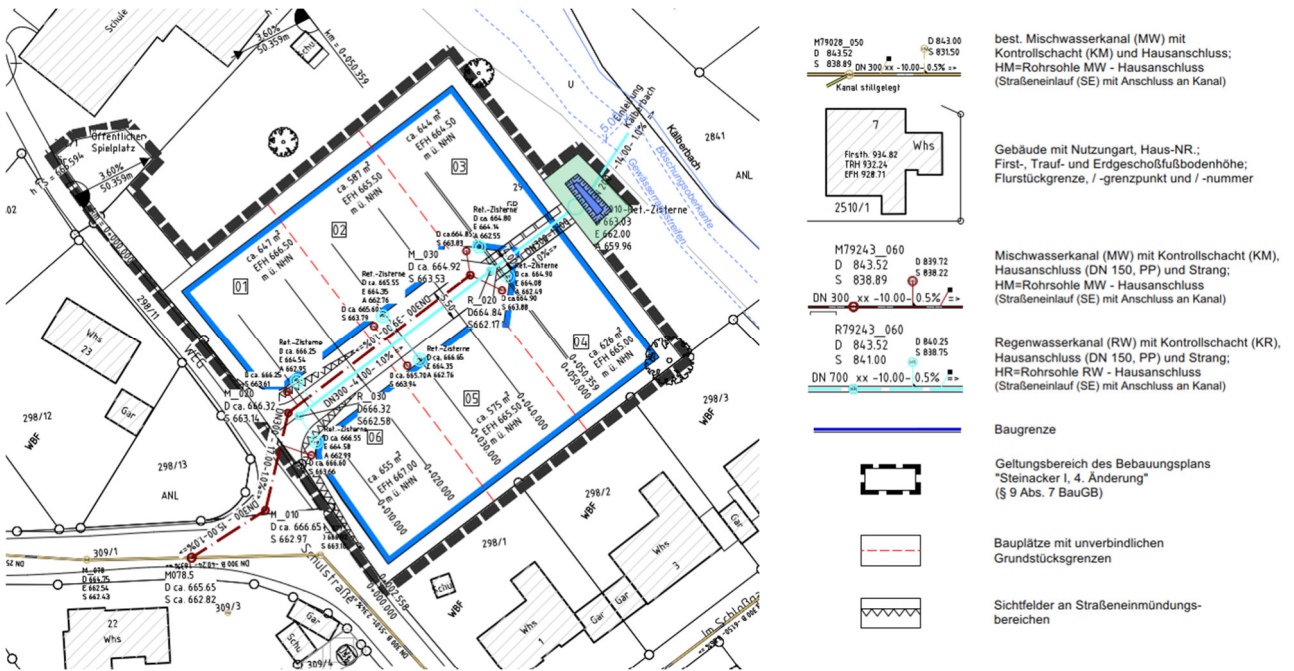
Lageplan mit Darstellung der Retentionszisternen (Planungsbüro Hermle, Stand 11.03.2026 mit Ergänzung vom Planungsbüro Fritz & Grossmann)
